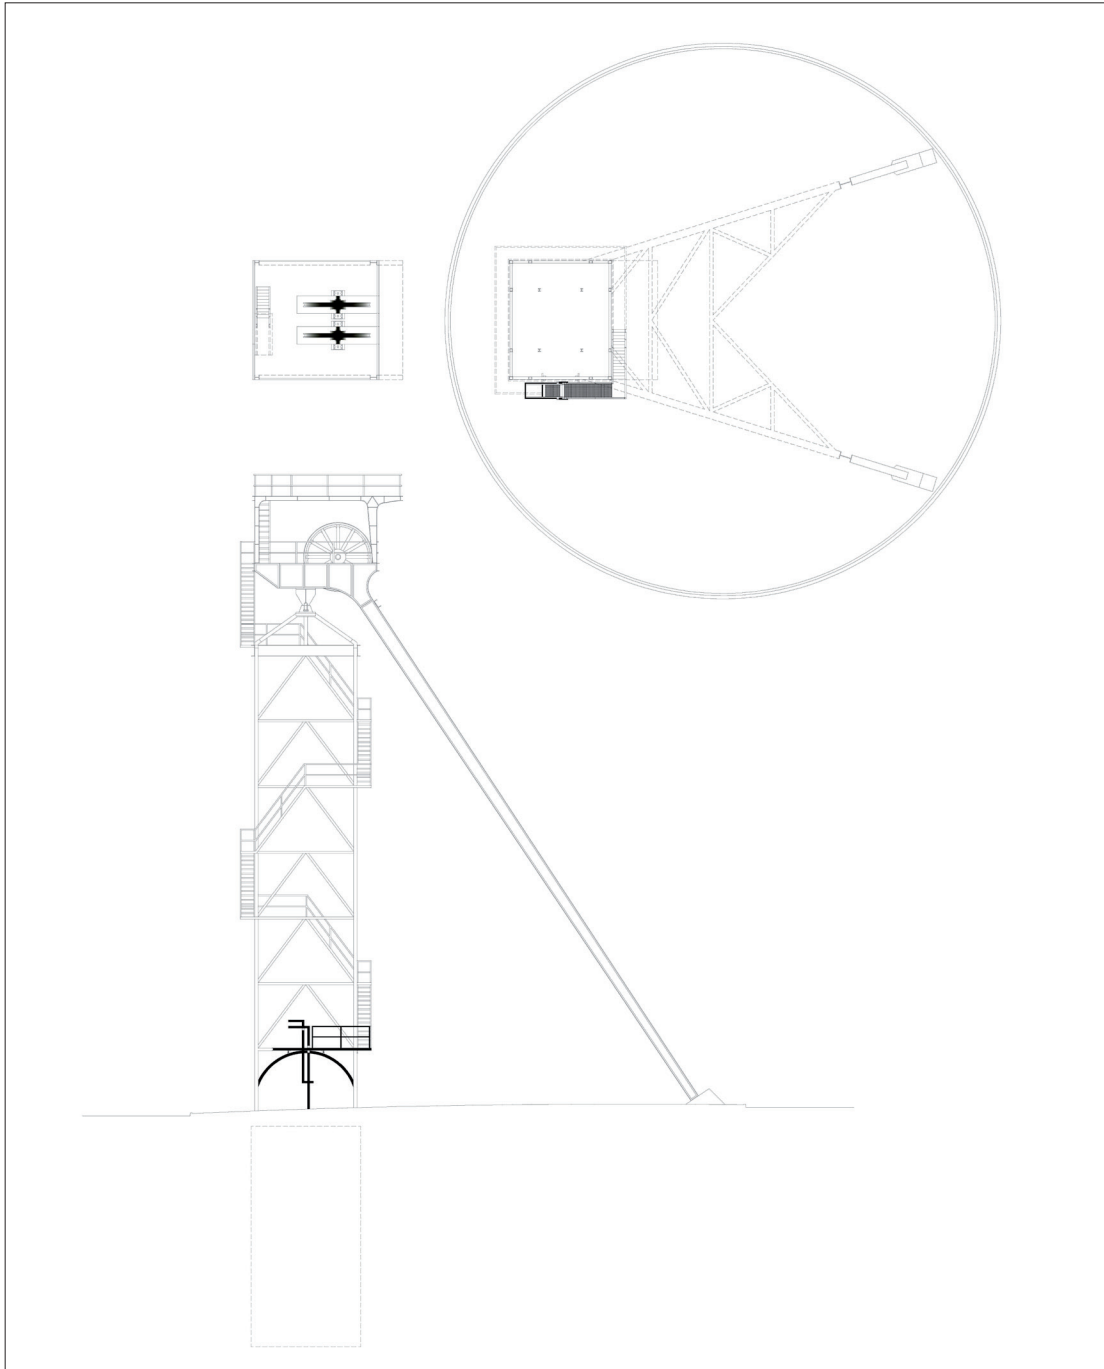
Plano general del castillete. Alzado lateral, plantas nivel terreno y plataforma de poleas.
